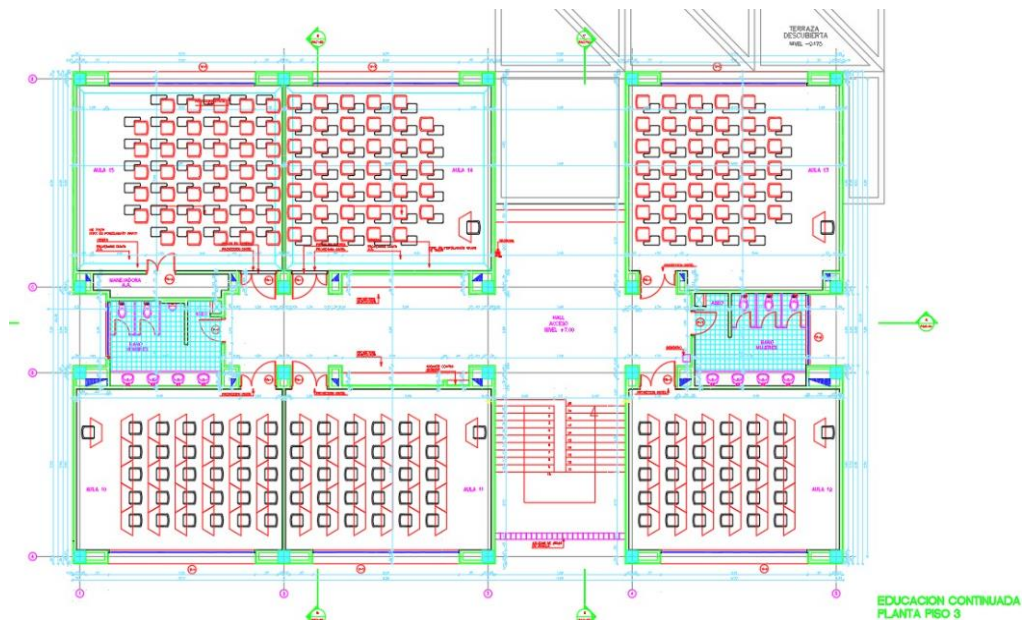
Plano arquitectónico de la planta 3 del edificio de educación continua.
